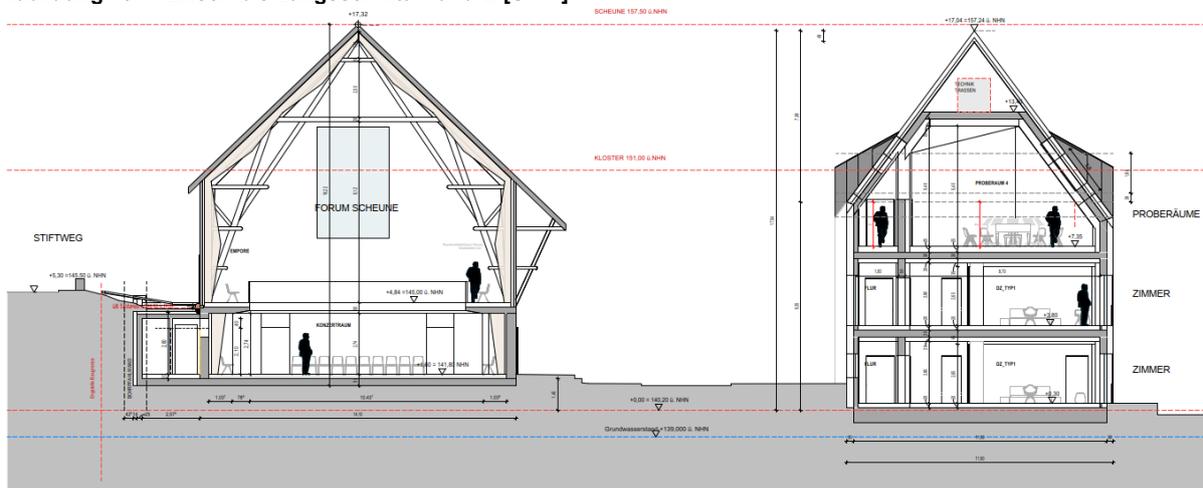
Ensemble Querschnitt C [U 1.1]
